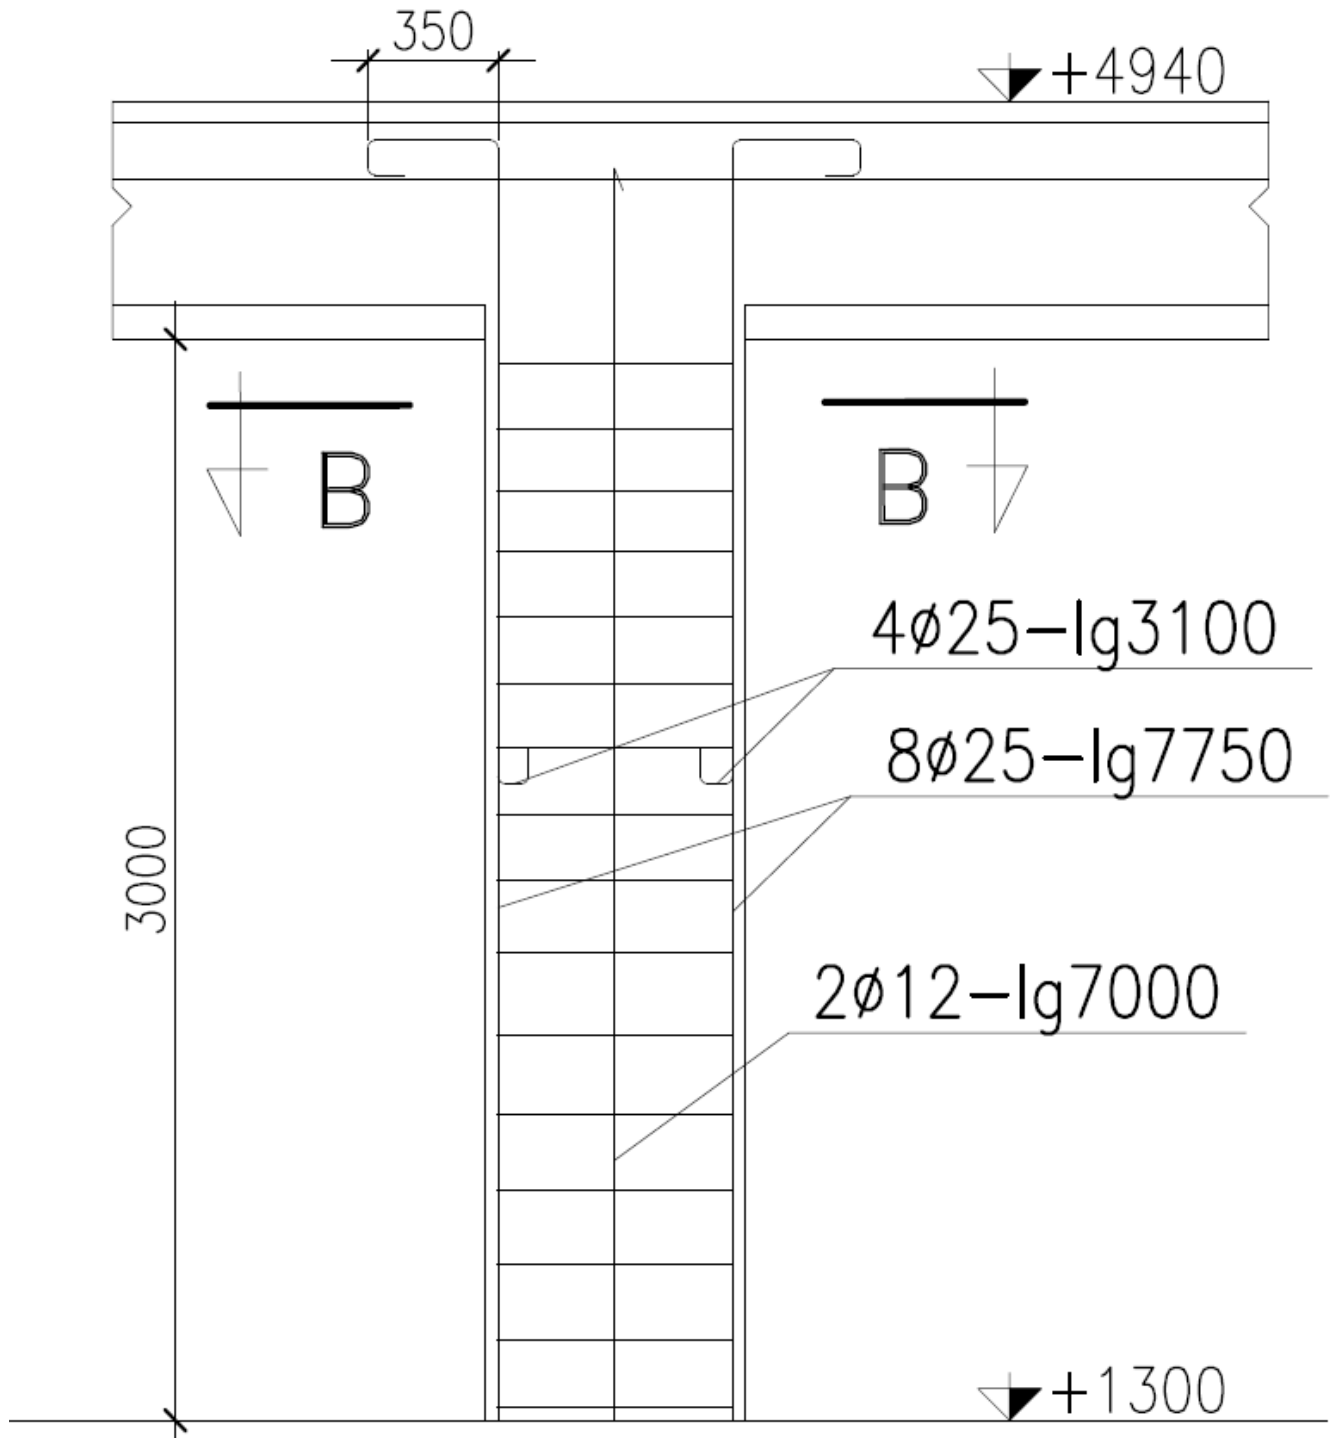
Particolare dei pilastri tipo "C", con i relativi ferri di armatura
